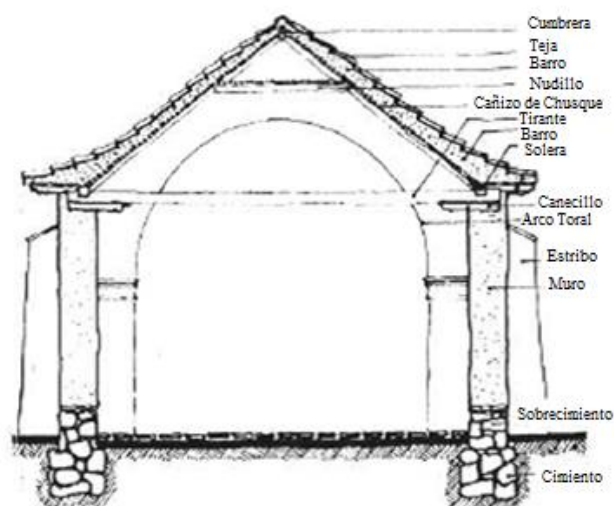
Sección transversal tipo (Caballero & Samayoa, 2010).
